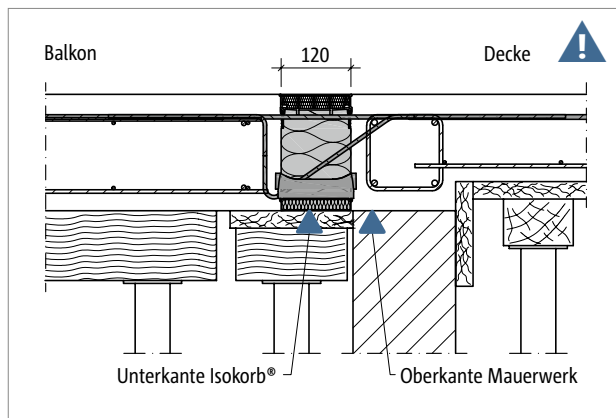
Schöck Isokorb® XT Typ K: Ortbetonbalkon mit höhenversetzter Decke auf Mauerwerkswand
